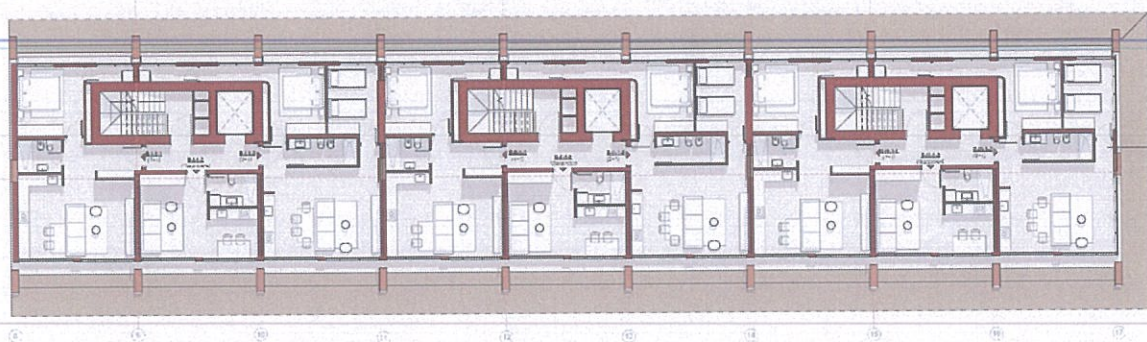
Planimetria e dimensionuar e katit +1 Objekti B
